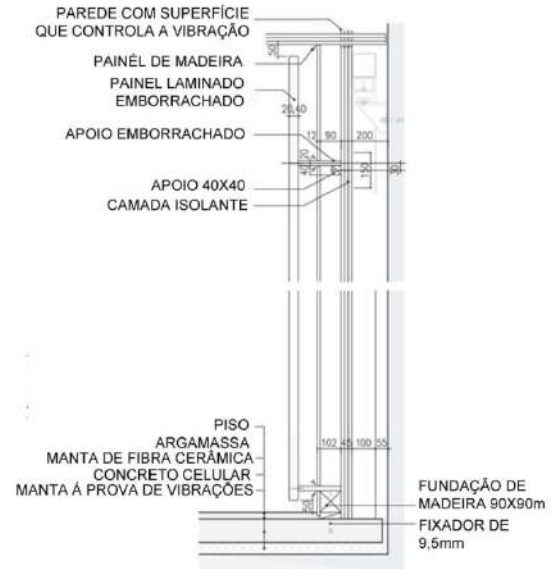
Esquema em corte do isolamento acústico. Fonte: ArchDaily, editado pela autora.
